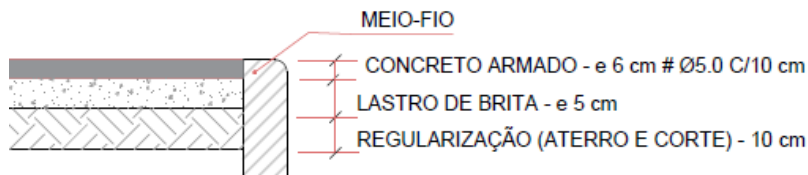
Corte Transversal – Execução de Concreto 6 cm Armado
